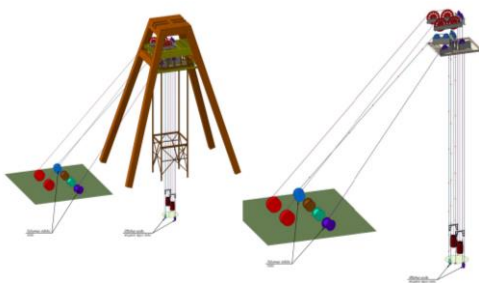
Использование двух лебедок для монтажа и навески армировочного полка, подъемных машин для спуска людей, материалов/грузов
